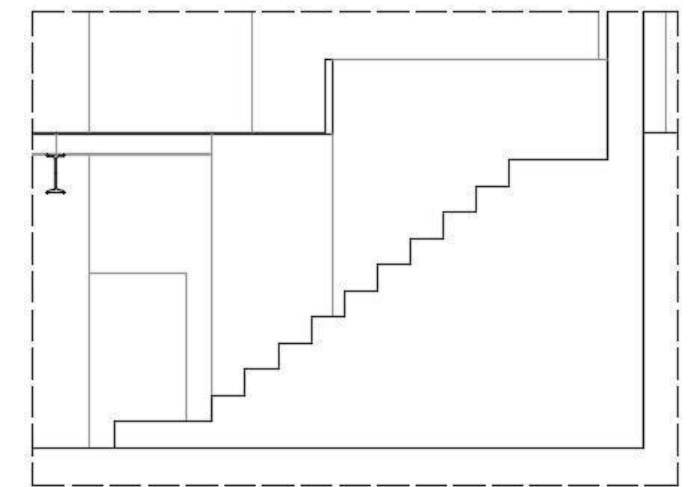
Entrada a escalera sótano Fuente: Propia
